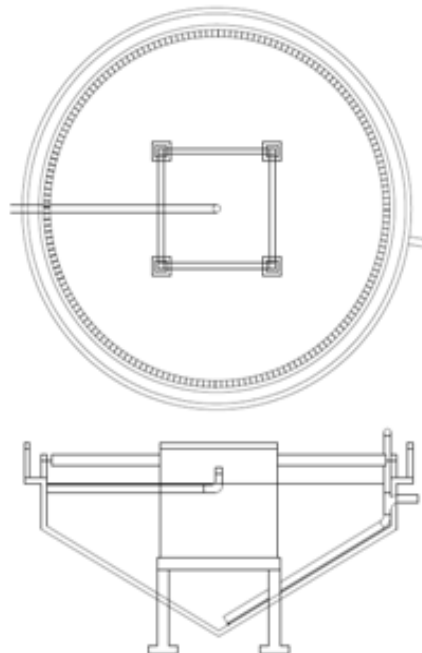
Vistas en planta y elevación de sedimentador circular
